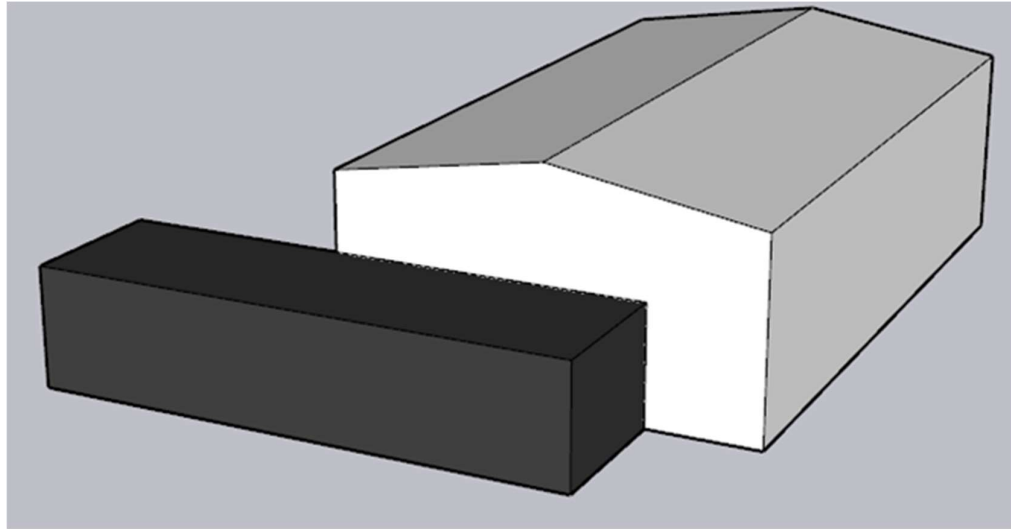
| Volúmenes de la planta de tratamiento, en forma esquemática. Elaboración propia
